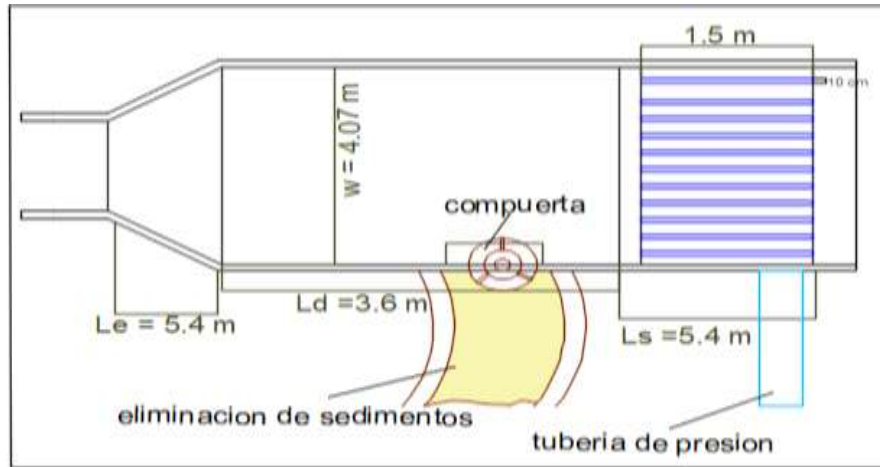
Vista de Planta del Desarenador y Cámara de Carga.
